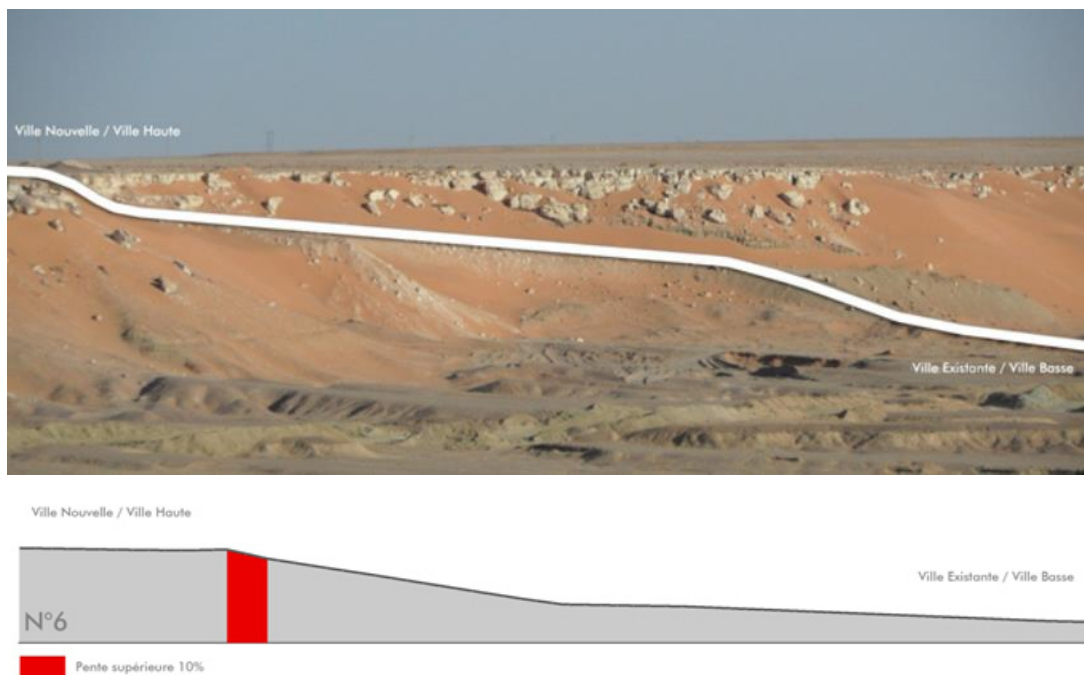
Panorama et profil en long sur le tracé N°6 accédant au plateau
